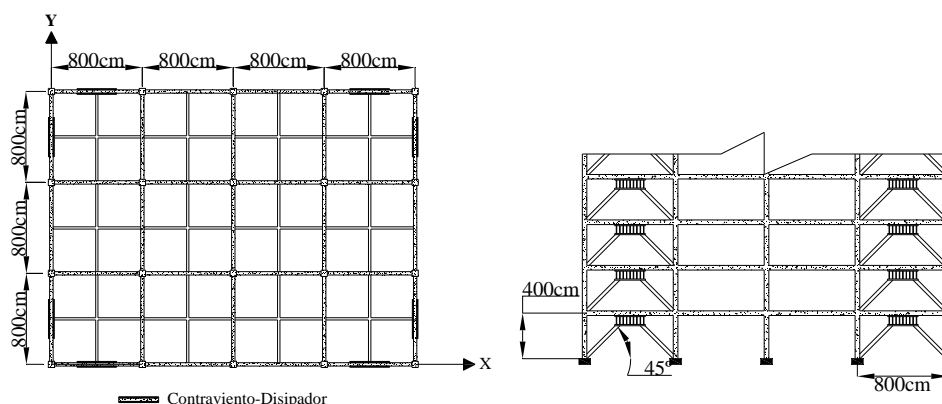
Elevación y planta de la configuración estructural de los modelos
